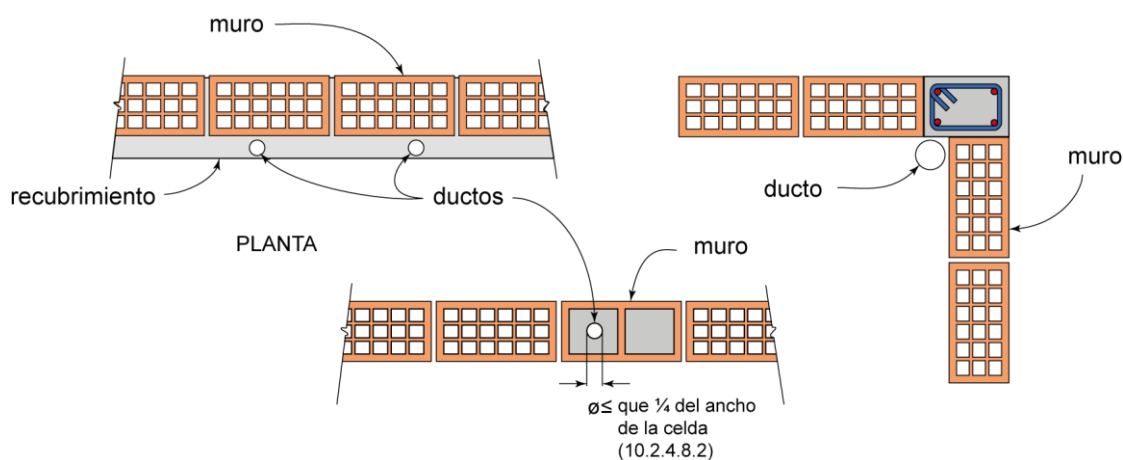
Ejemplos de ductos fuera del muro o en piezas huecas
